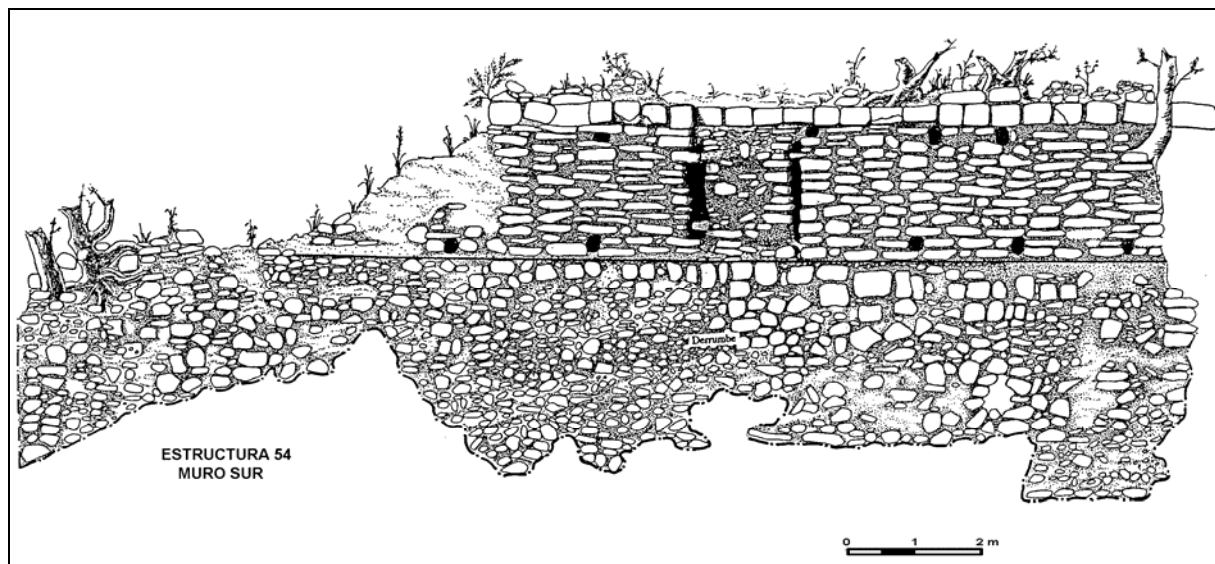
Muro sur de la Estructura 34, anterior a su consolidación
